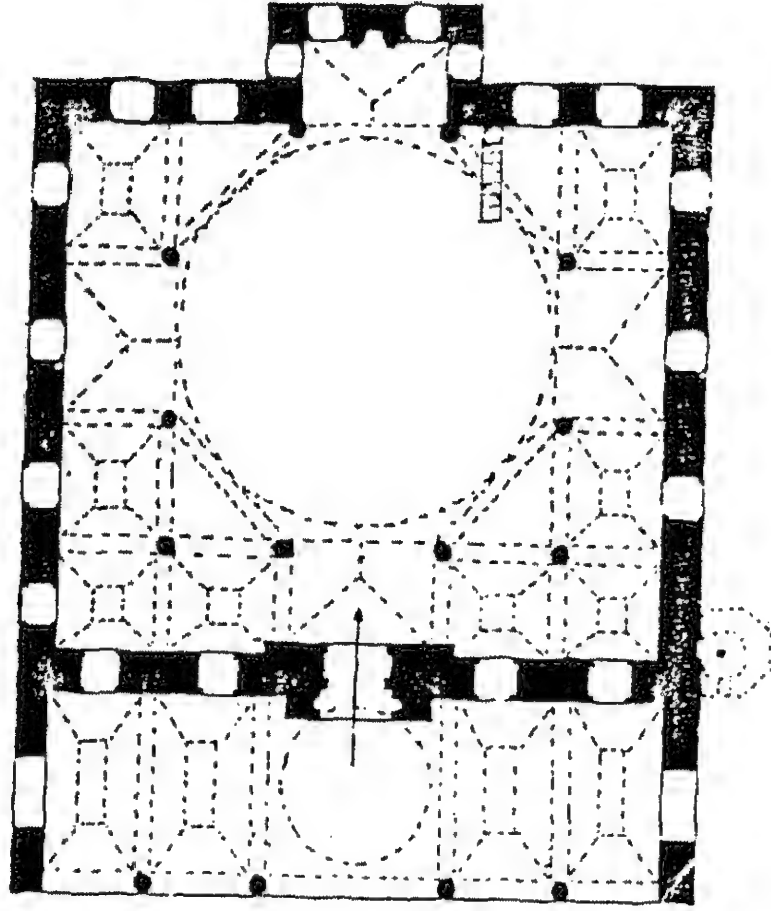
مسقط أفقي لمسجد عتيق علي باشا في زنجرلى قويو باستانبول
